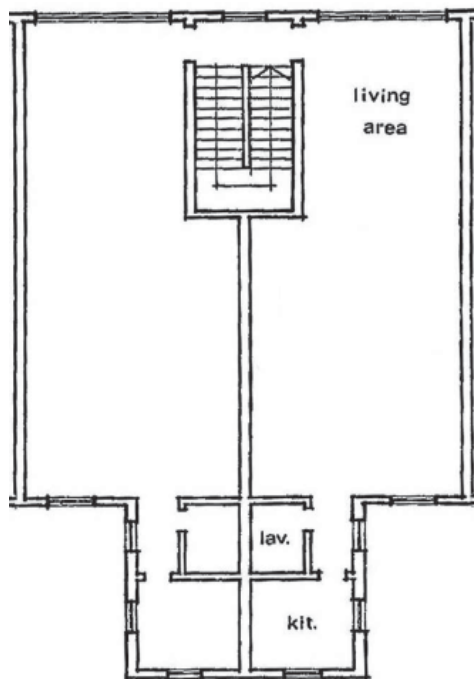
Tong Lau mit natürlich belüftetem Treppenhaus, entsprechend der Baugesetzgebung von 1935, Grundriss
